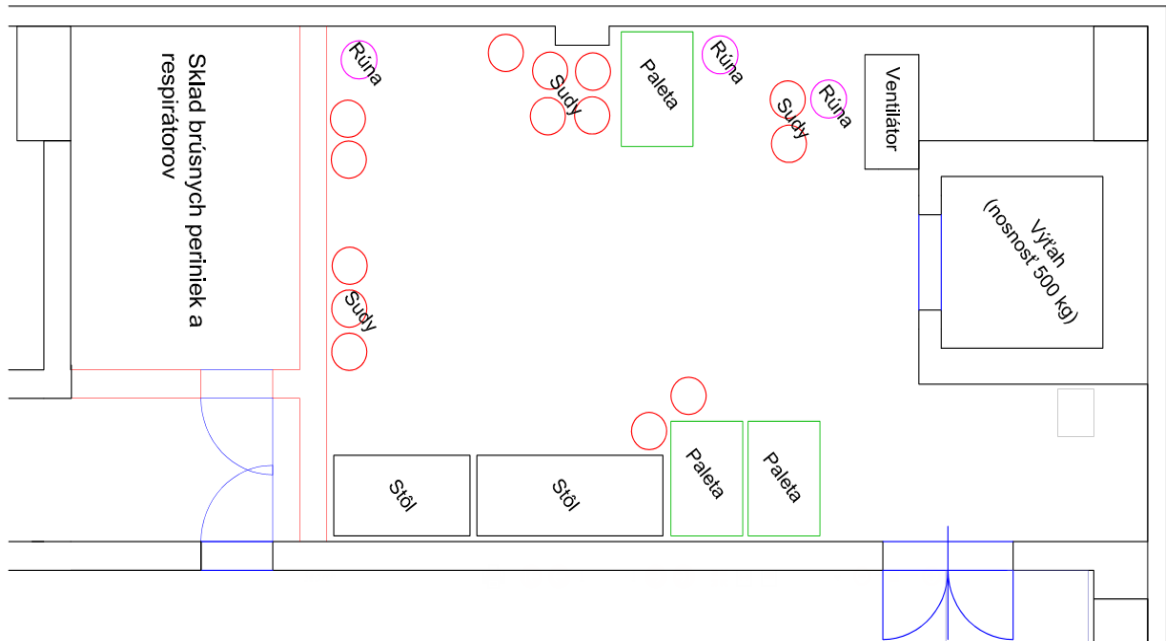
Príručný sklad lakov v budove 100 - nový závod, prízemie (vlastné spracovanie)
